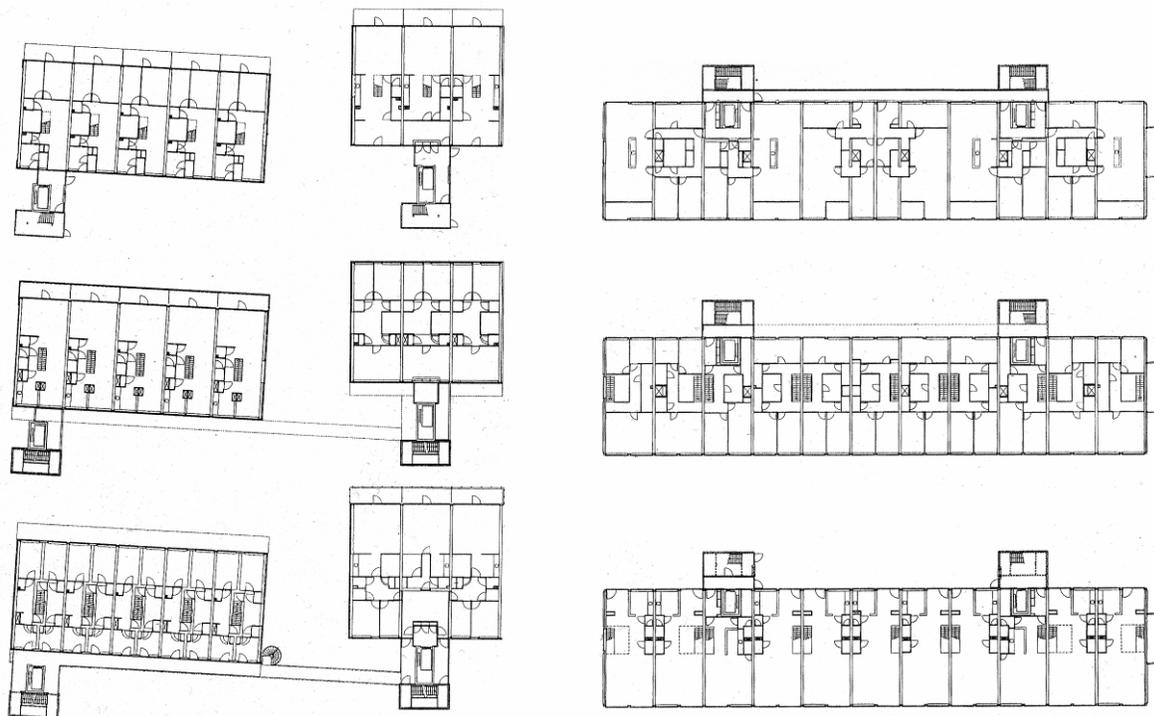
Planta do edifício com dois blocos e planta do edifício “container” (s/ esc).
